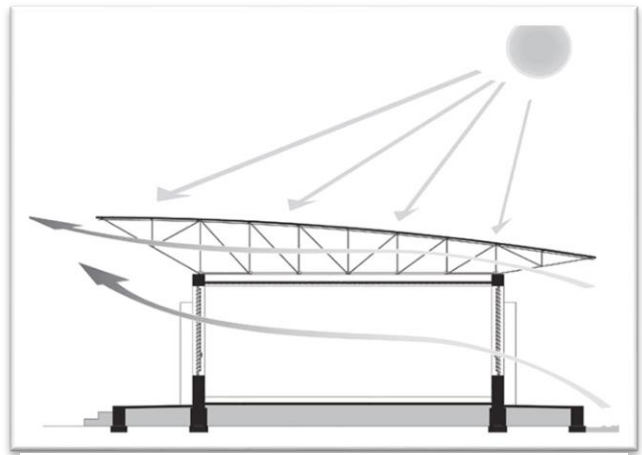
Planta arquitectónica y corte. <http://s-ar.mx/información>
